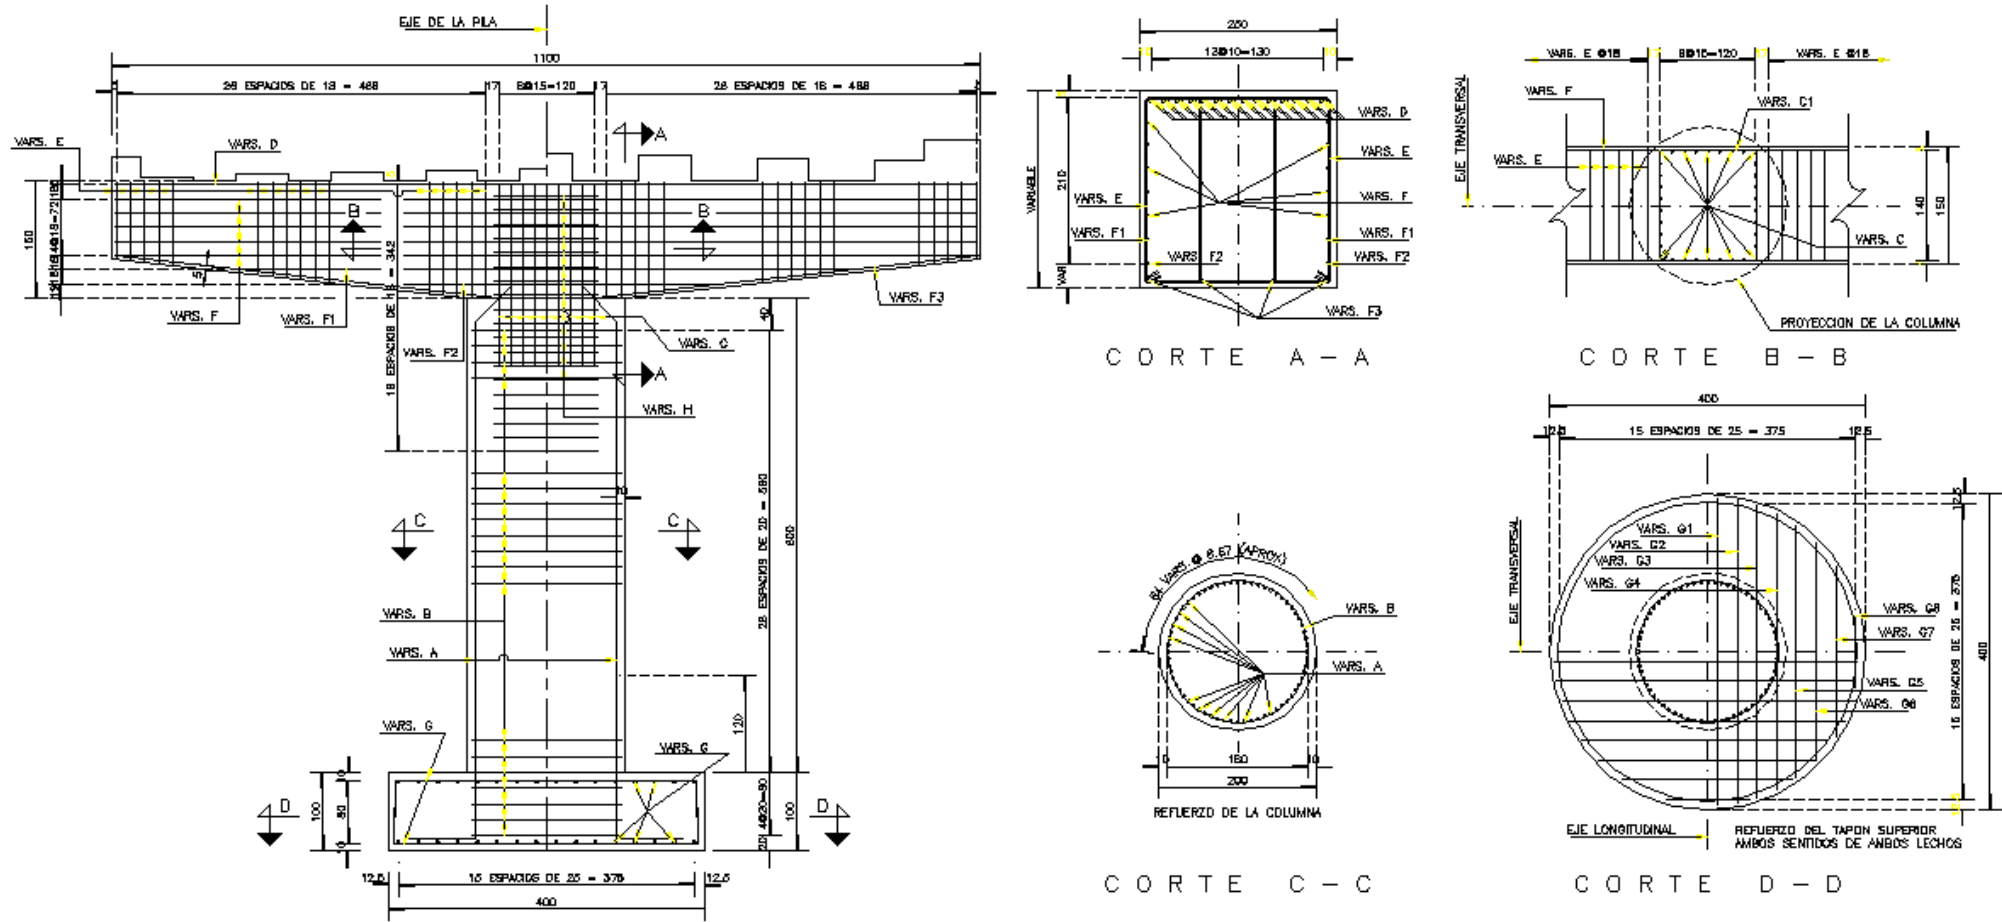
Esquema de refuerzo de las pilas No. 2, 3 y 4. (Sin escala, cotas en cm).
